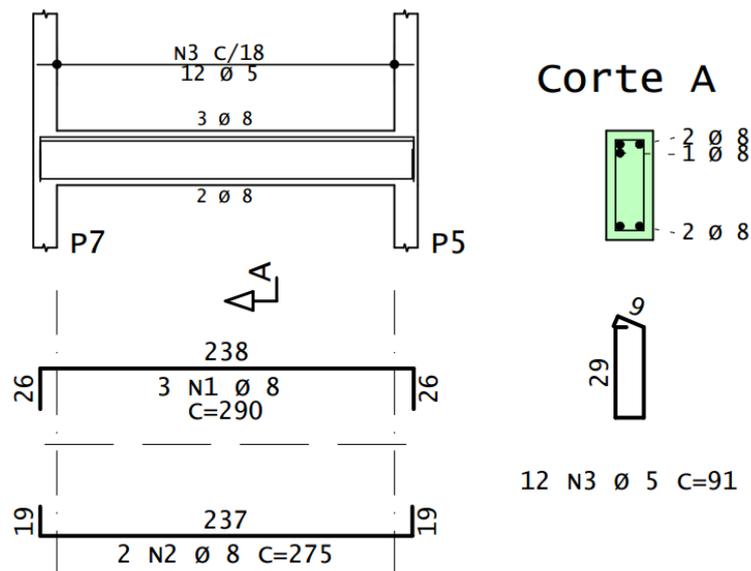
Armadura da viga baldrame V10 – pavimento térreo (nível 0,00)
